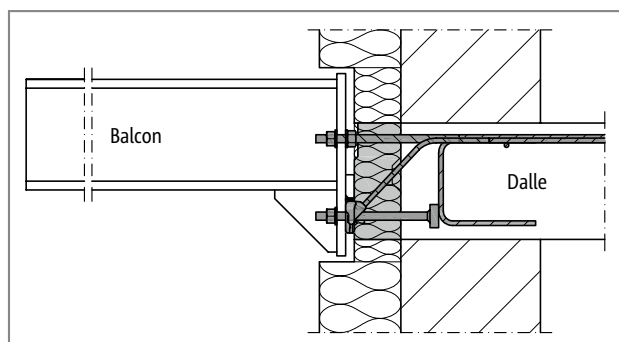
Schöck Isokorb® T type SK : Transition sans obstacle grâce au décalage en hauteur
